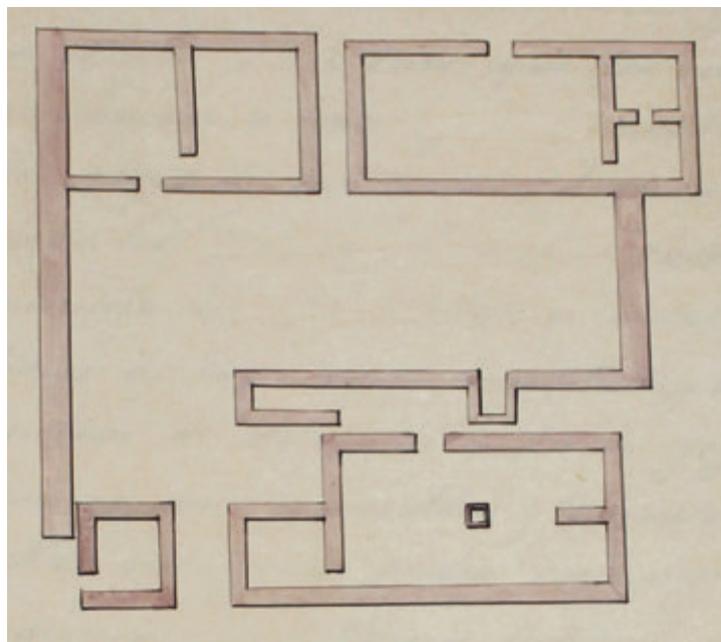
, plano no. 2. Plano de un edificio de Tollan. Dibujo a pluma.
